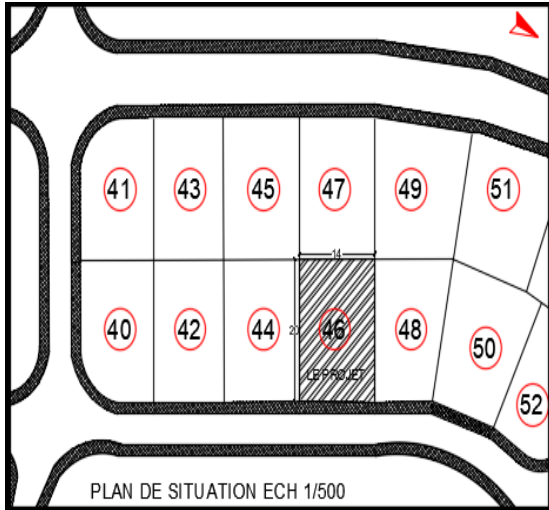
plan de situation ech 03 (source: propriétaire)
